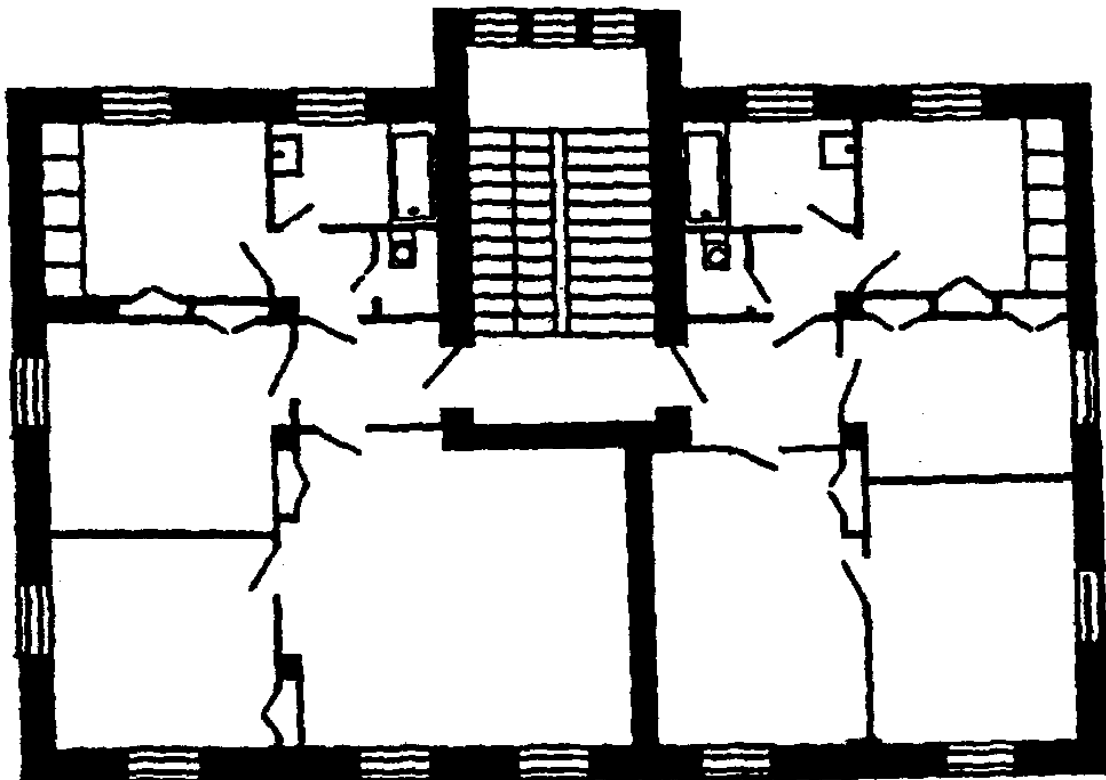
План верхнього поверху двоповерхового будинку забудови 50-х років, який за плануванням близький до будинків першого виду
